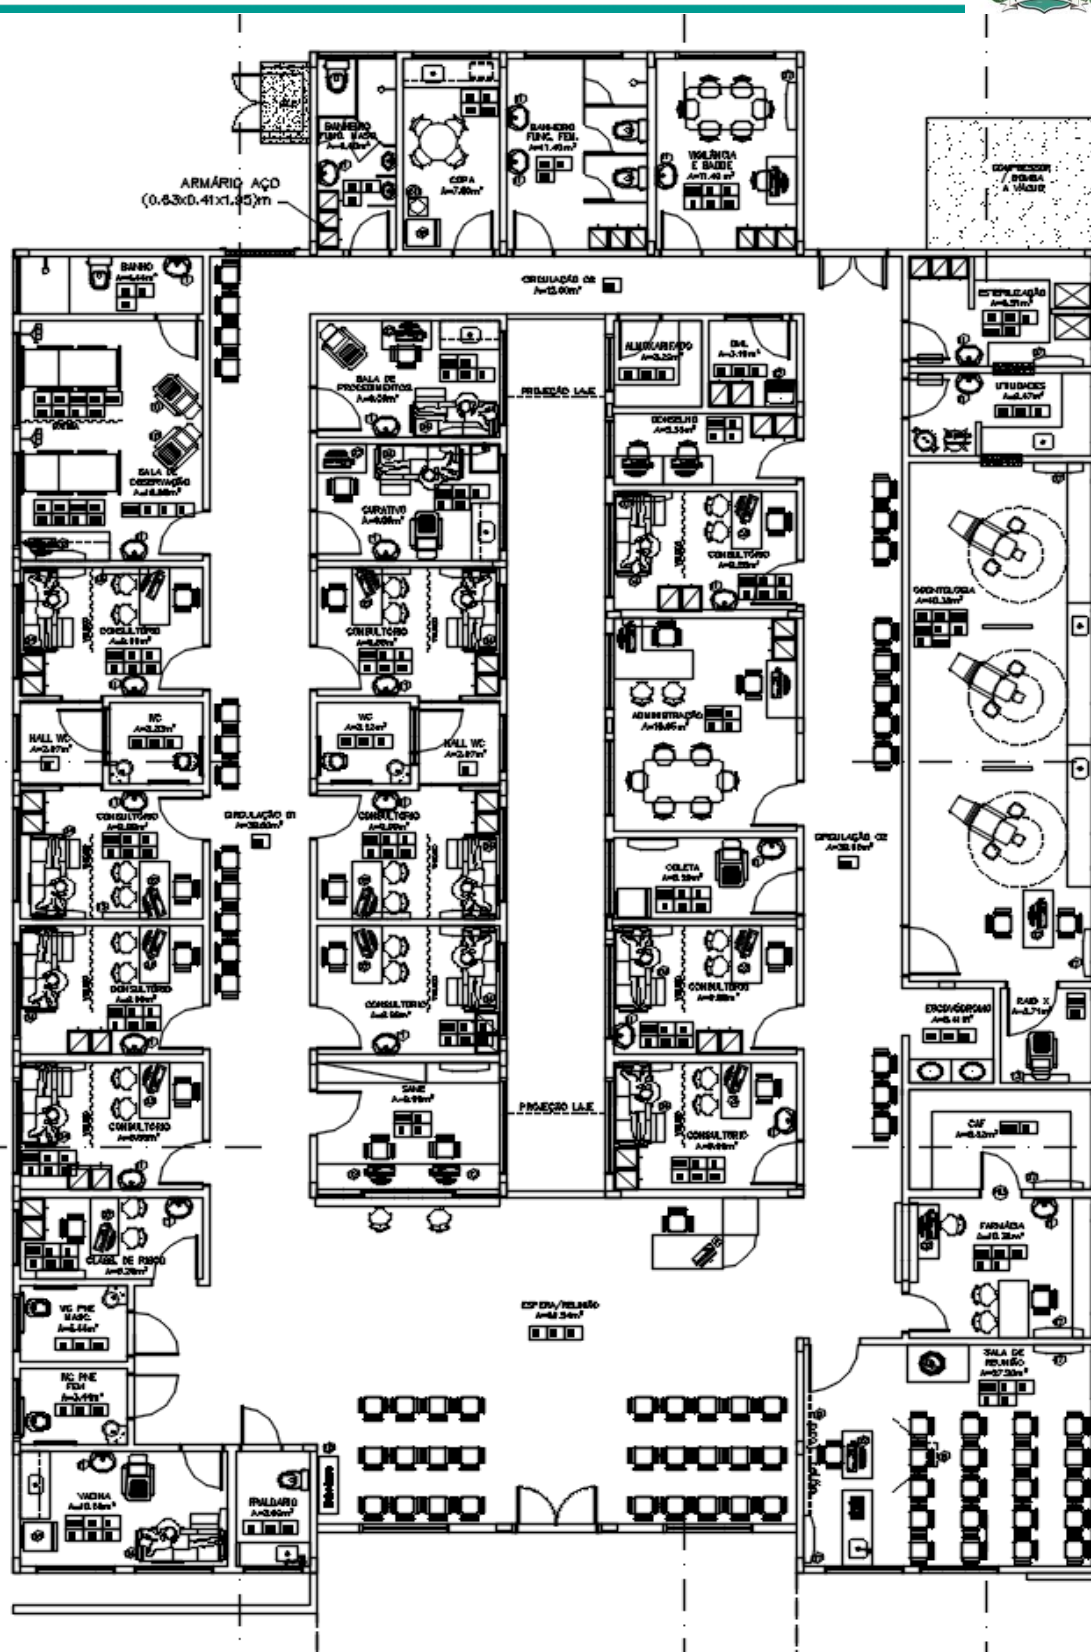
Planta Baixa – Unidade Basica de Saúde (UBS).
